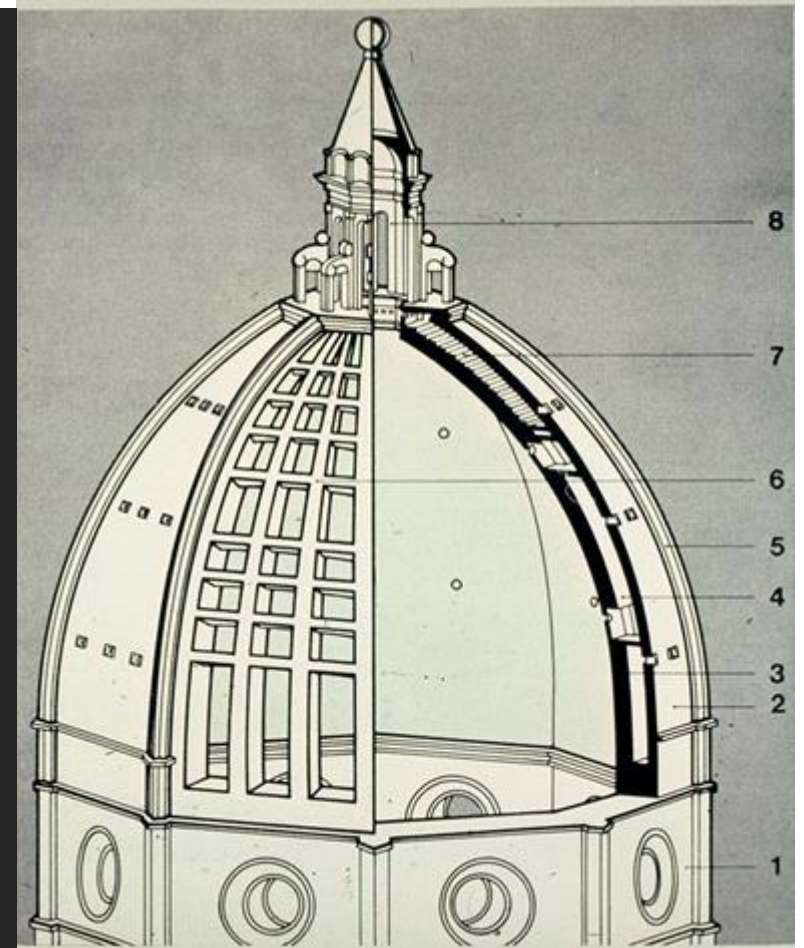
e 88: Desenhos da estrutura da Cúpula Santa Maria del Fiore, Brunelleschi (1377-1446), 1418.
